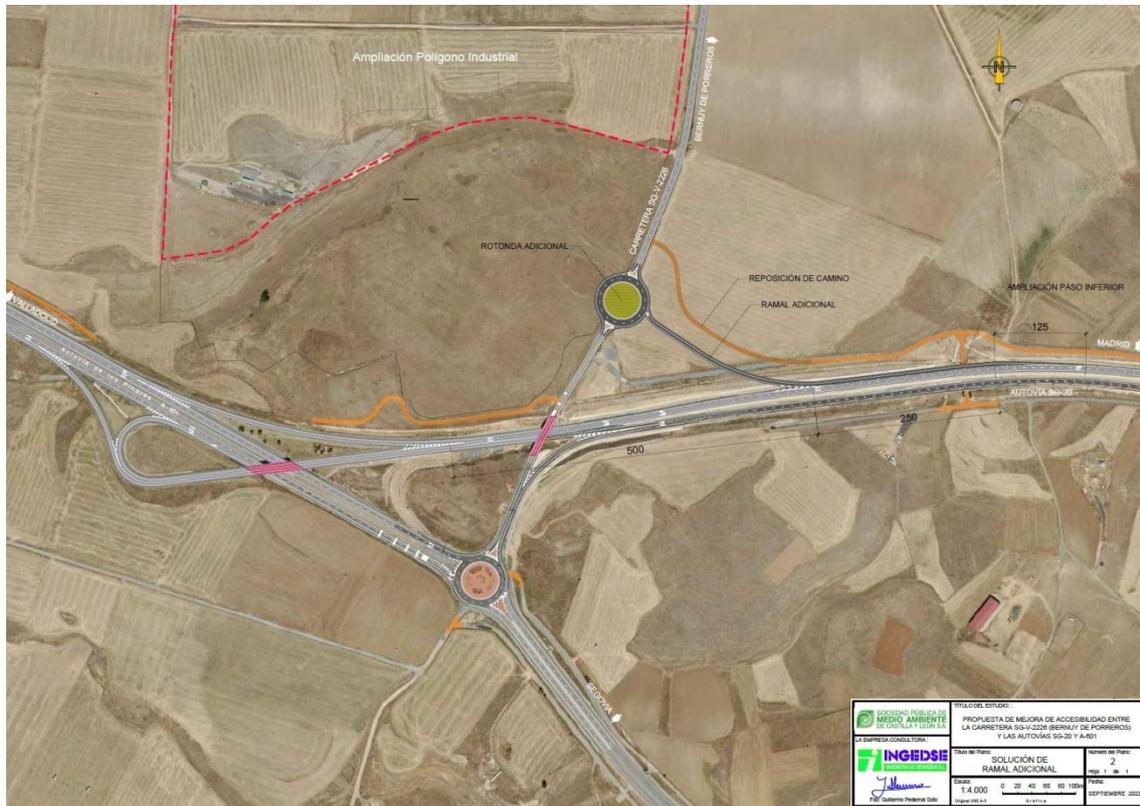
Propuesta preliminar de mejora de accesibilidad con la construcción de una salida desde la SG-20 y rotonda de conexión con la SG-V-2226, mediante ramal adicional
